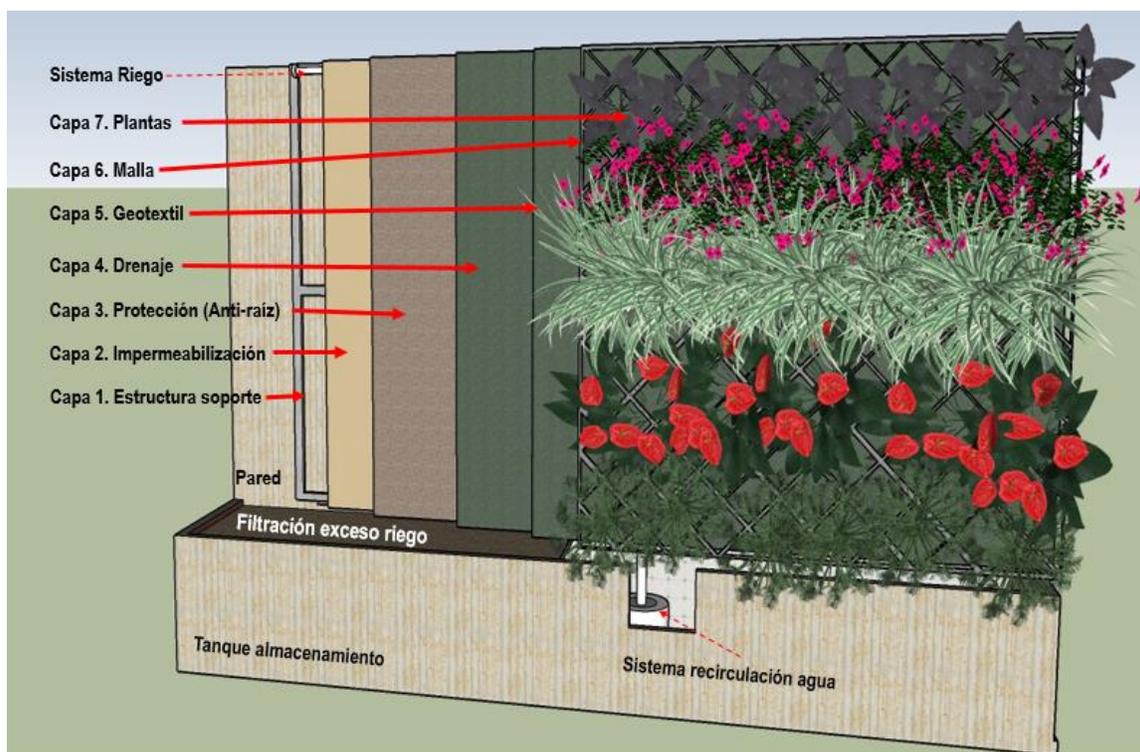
Estructura muro verde por capas (Sketchup, 2018)
